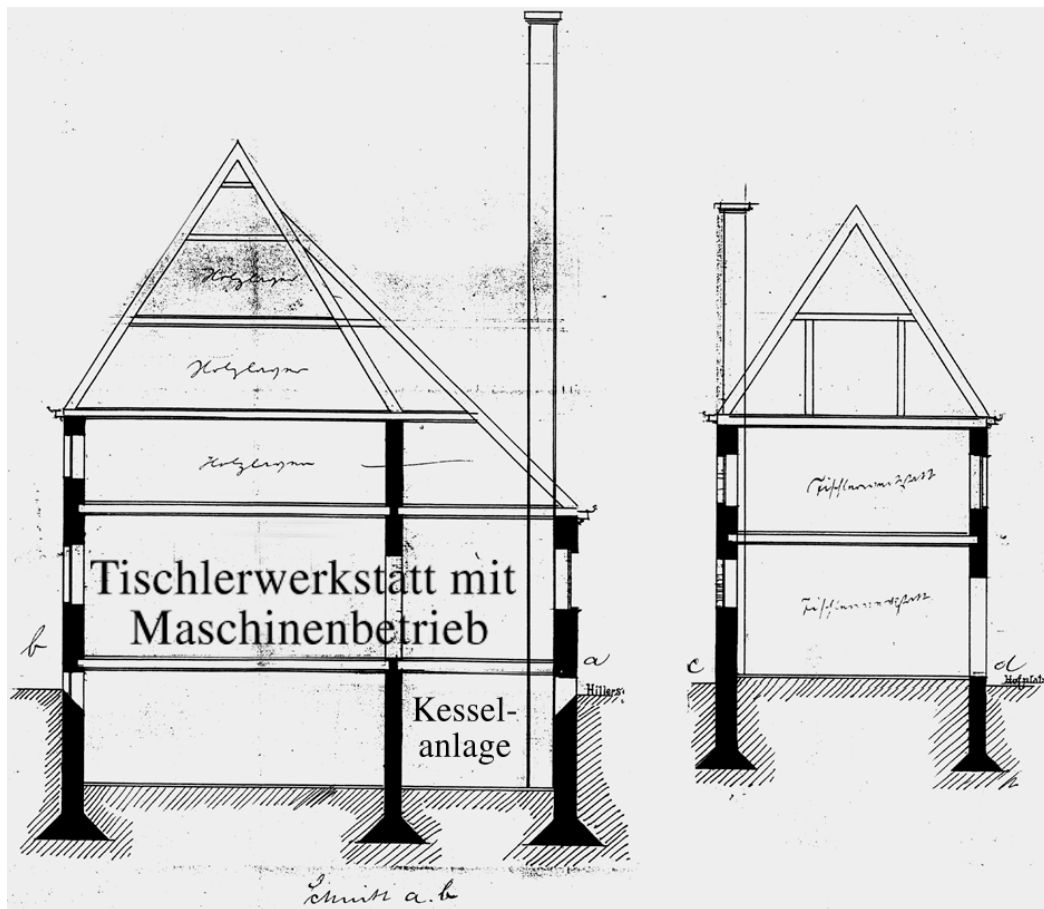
„Umbau eines Packhauses mit Hinterhaus zu einer Tischlerwerkstätte mit Dampfbetrieb für J. Chr. Söncksen, 1888.“
